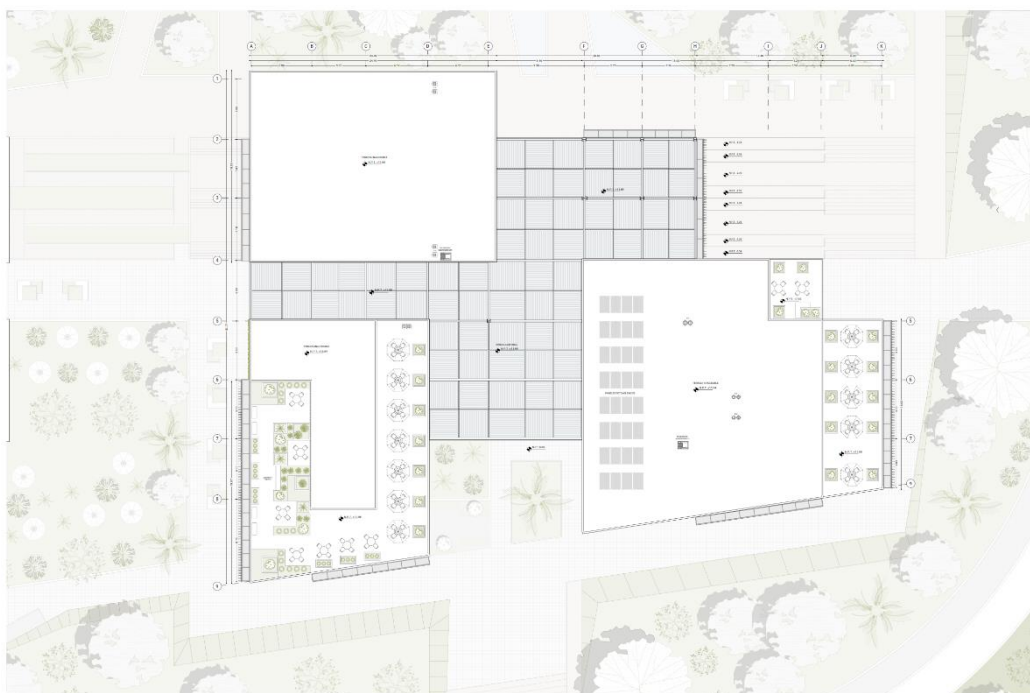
Planta de cubiertas - N + 15.84 (Gualavisí N., 2022)
